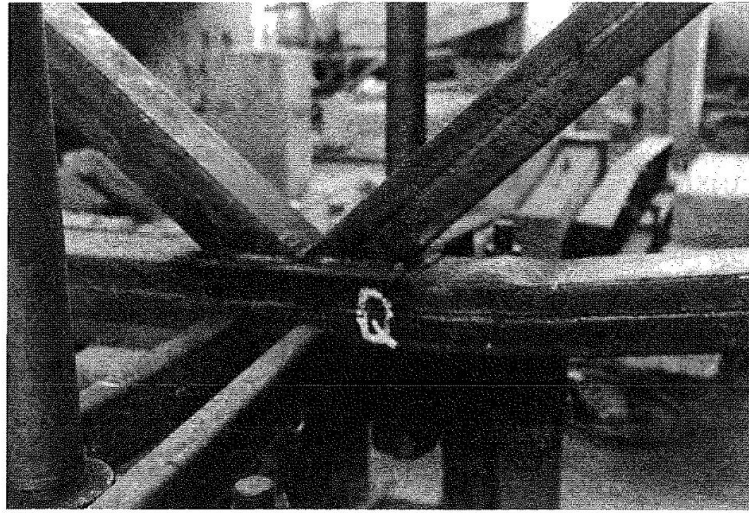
Фото зварного з'єднання Q після руйнування на випробувальному комплексі [22]
